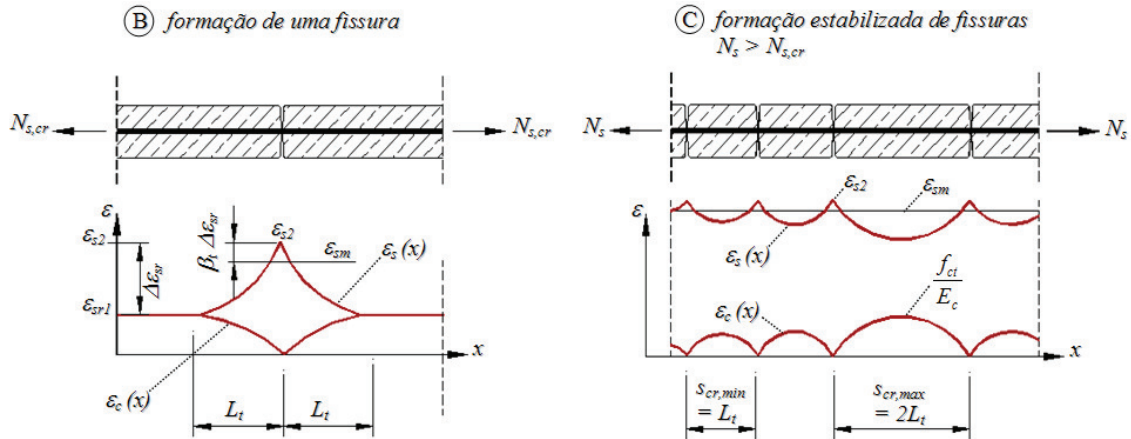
Distribuição da deformação na armadura e no concreto fissurado
